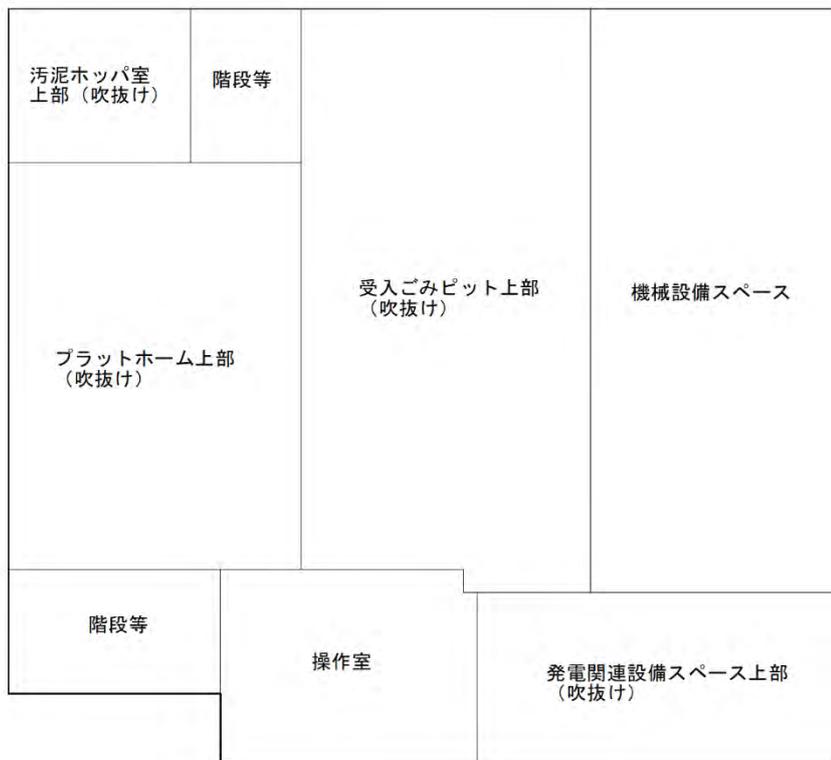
(4) 廃棄物受入棟平面図 (3 階)
